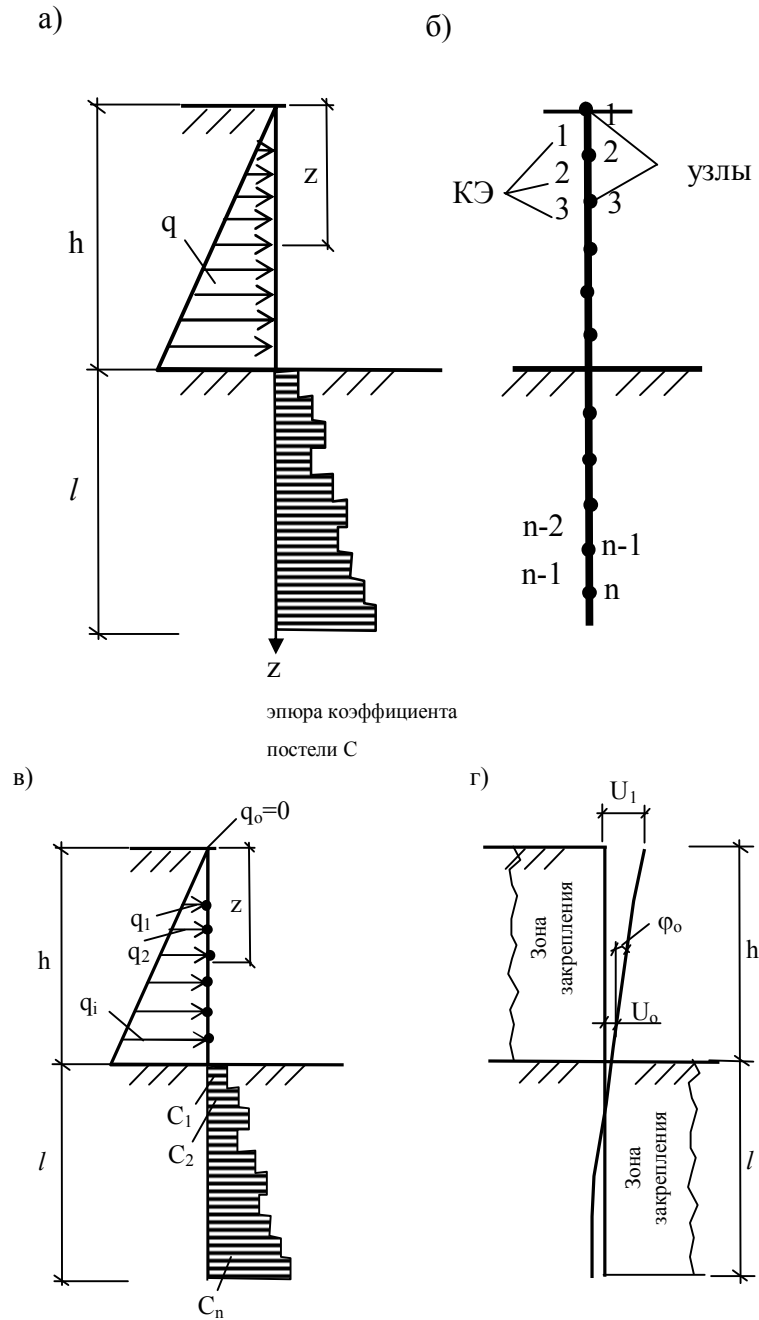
Расчетная схема: а) схема нагрузки и сопротивления грунта; б) схема дискретизации на КЭ; в) приведенная конечноэлементная схема нагрузок и сопротивления грунта; г) деформационная схема
